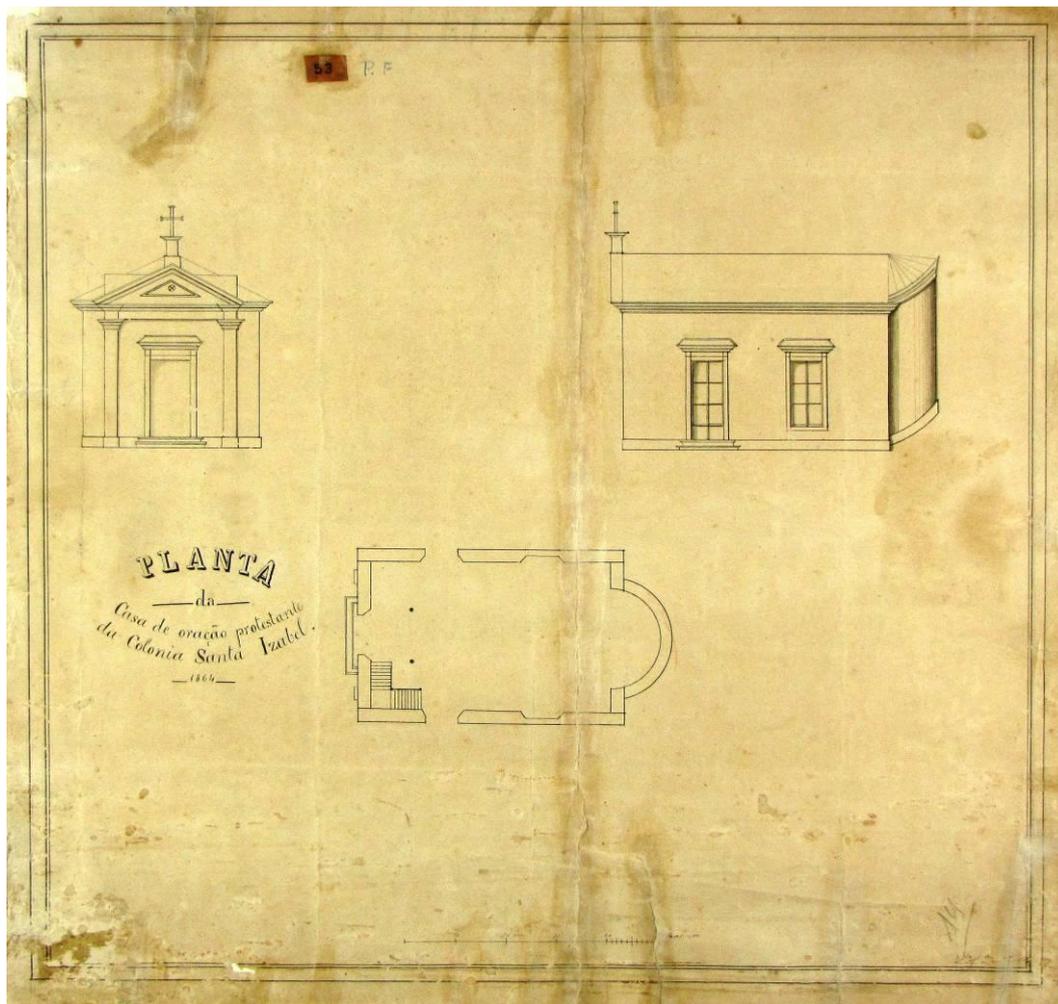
Planta da Casa de Oração Protestante da Colônia de Santa Isabel, 1864.
